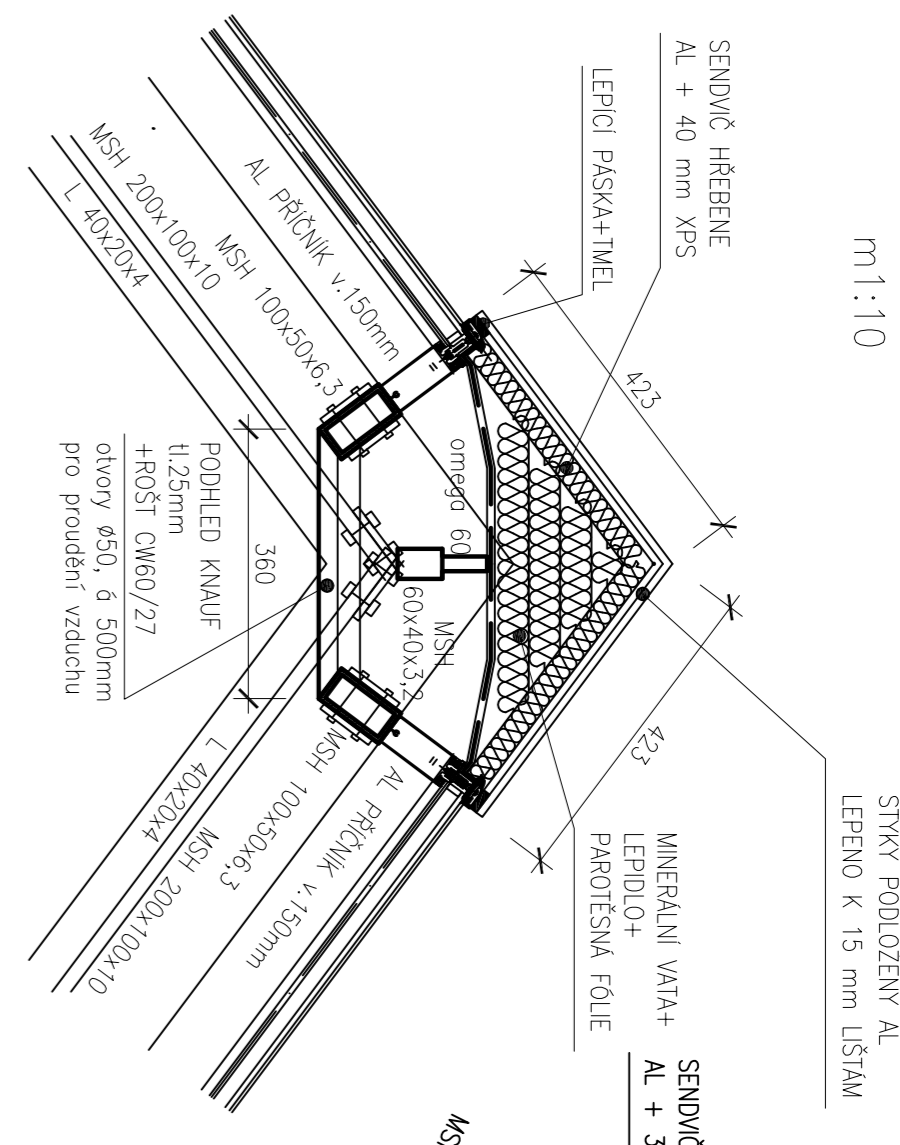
DETAIL PRÍČNÍKU STŘEŠNÍHO PĚŠTĚ
